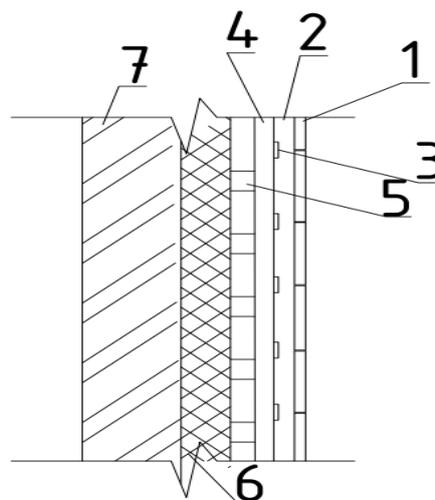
Схема вентилируемого фасада: 1 – облицовочные плиты из керамогранита; 2 – воздушный зазор; 3 – кляммер; 4 – вертикальный профиль; 5 – горизонтальный профиль; 6 – утеплитель; 7 – кирпичная кладка [1]
